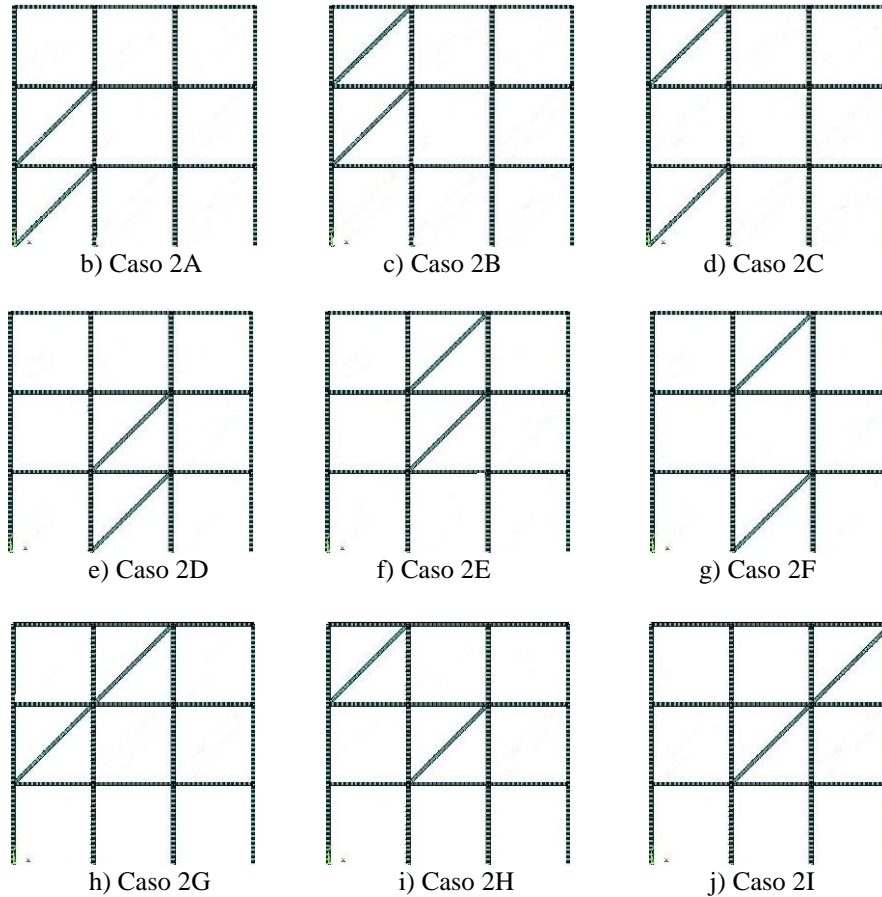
Pórtico com 3x3 pavimentos – caso 2
